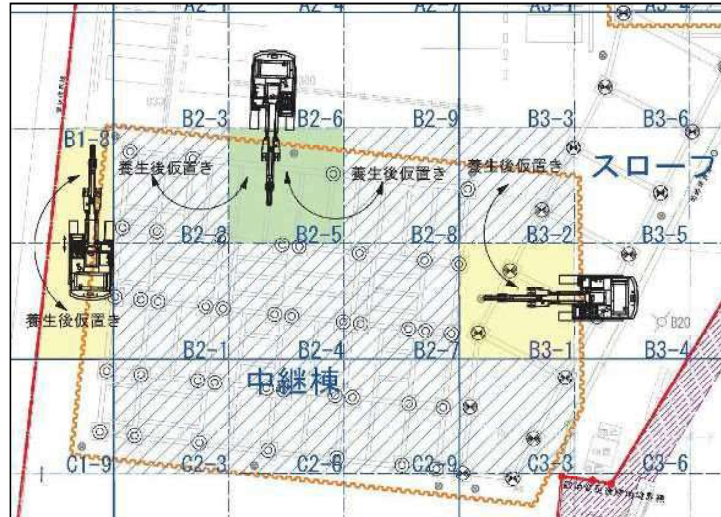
土地の形質の変更の施工方法を明らかにした平面図
